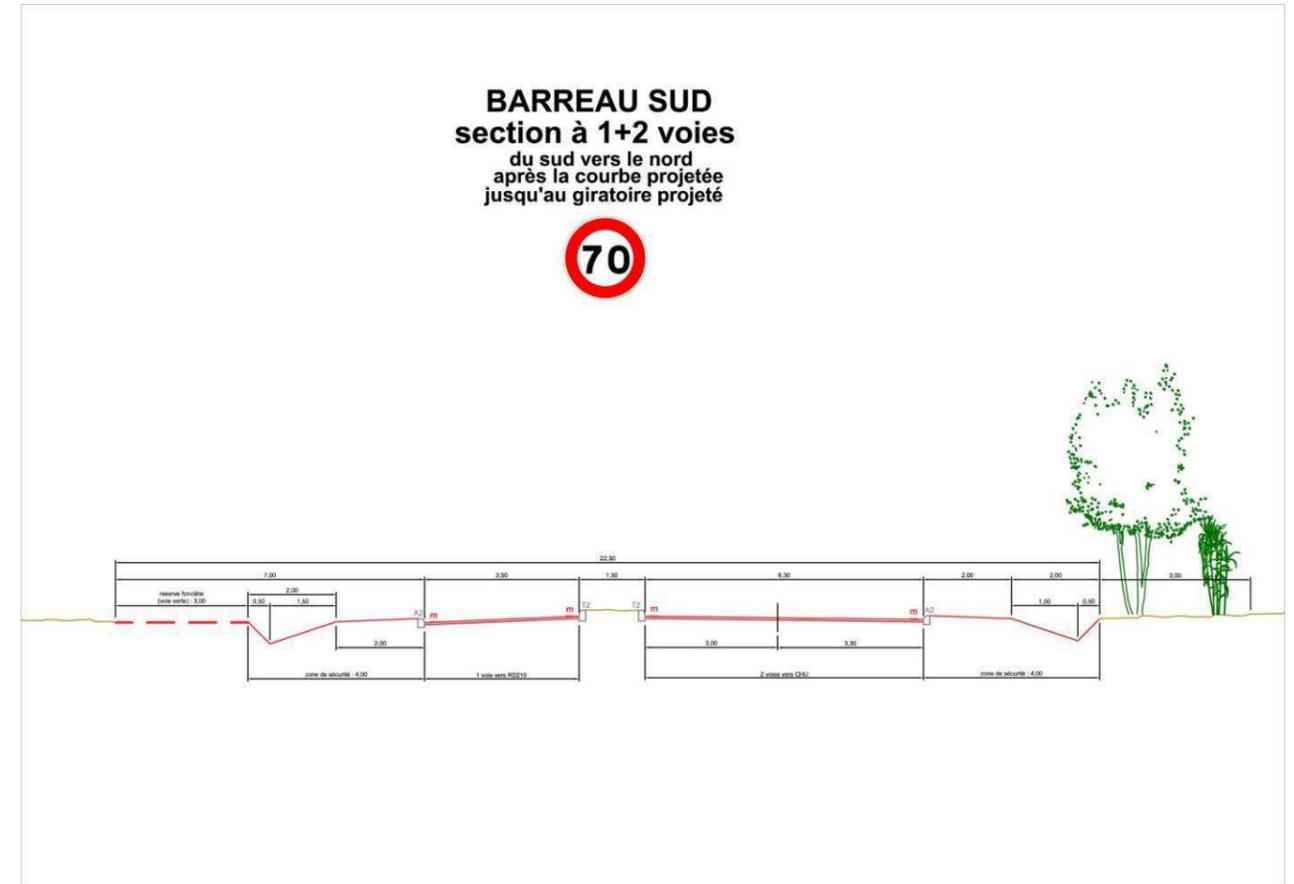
Profil en travers type du barreau Sud sur la section à 1+2 voies
